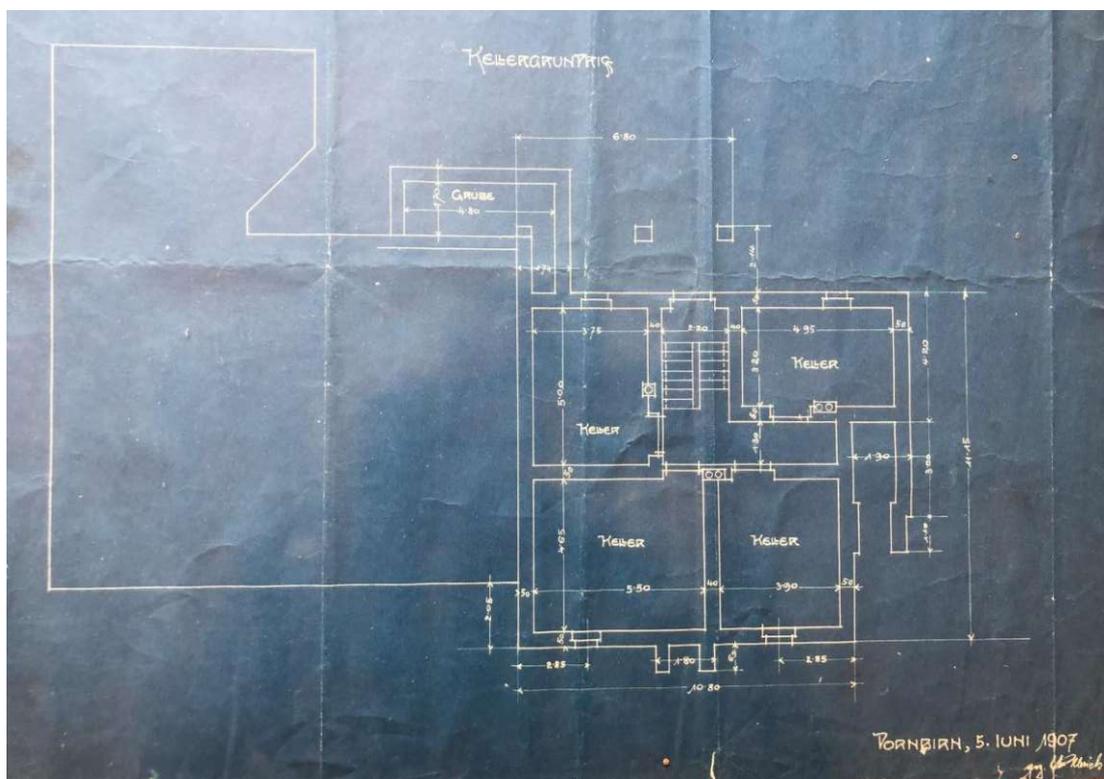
Kellergrundriss (Wohnhaus unterkellert) (Plandatum: 05.Juni 1907, eigenes Foto)
